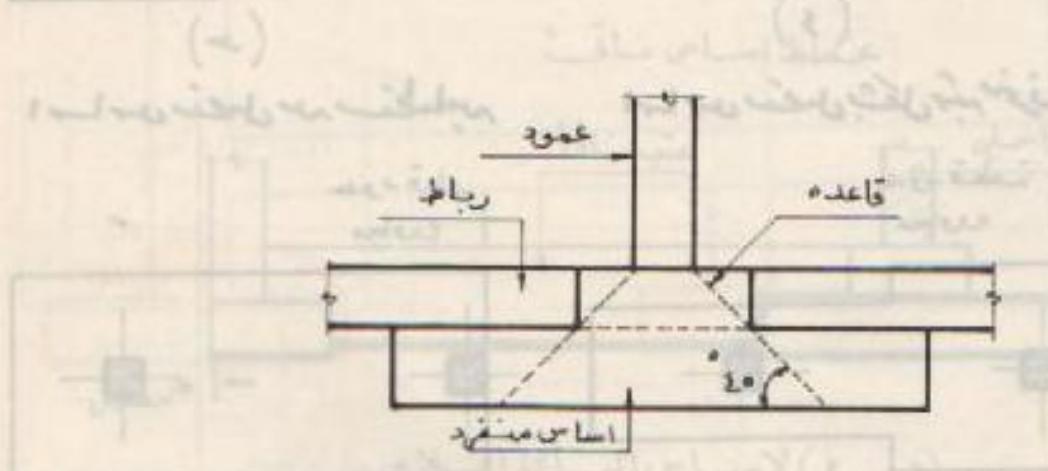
٩) مخطط وقطع أساس منفرد مع رباط من الخرسانة المسلحة
